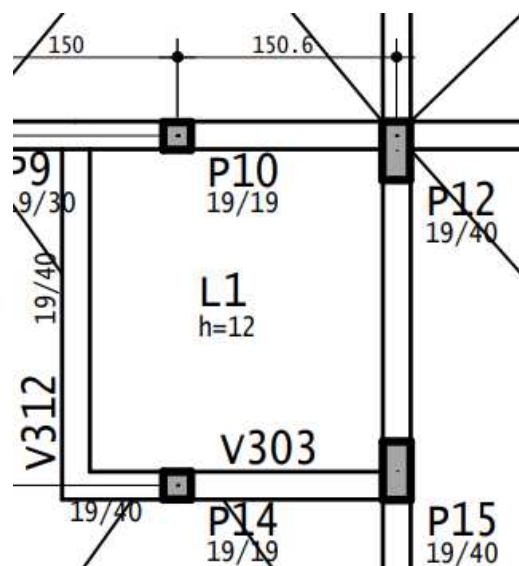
Planta de forma laje da caixa d'água (concepção otimizada)
